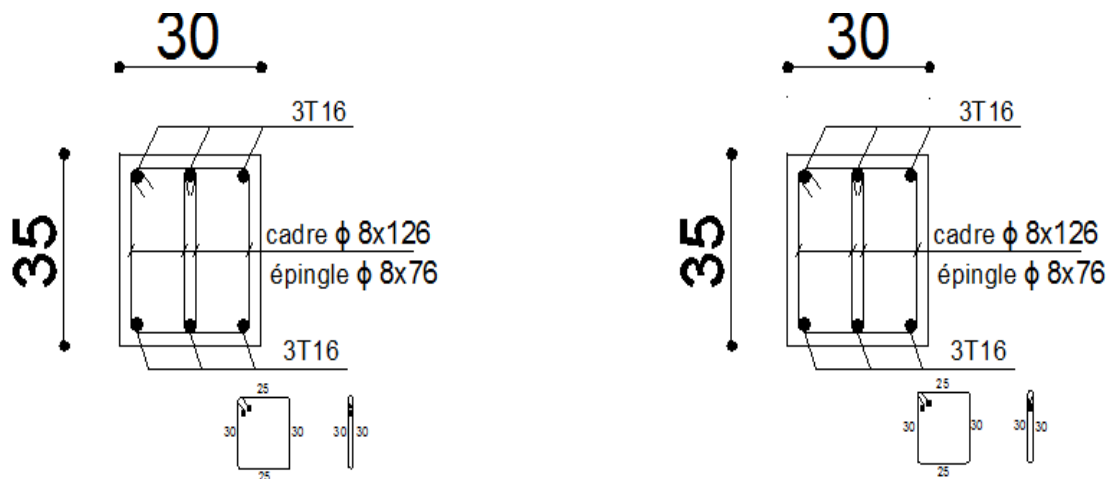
Dessin de ferrailage de la poutre brisée en appui et en travée
